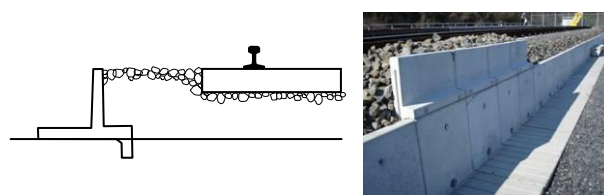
鉄筋コンクリートブロック製バラスト流出防止工
